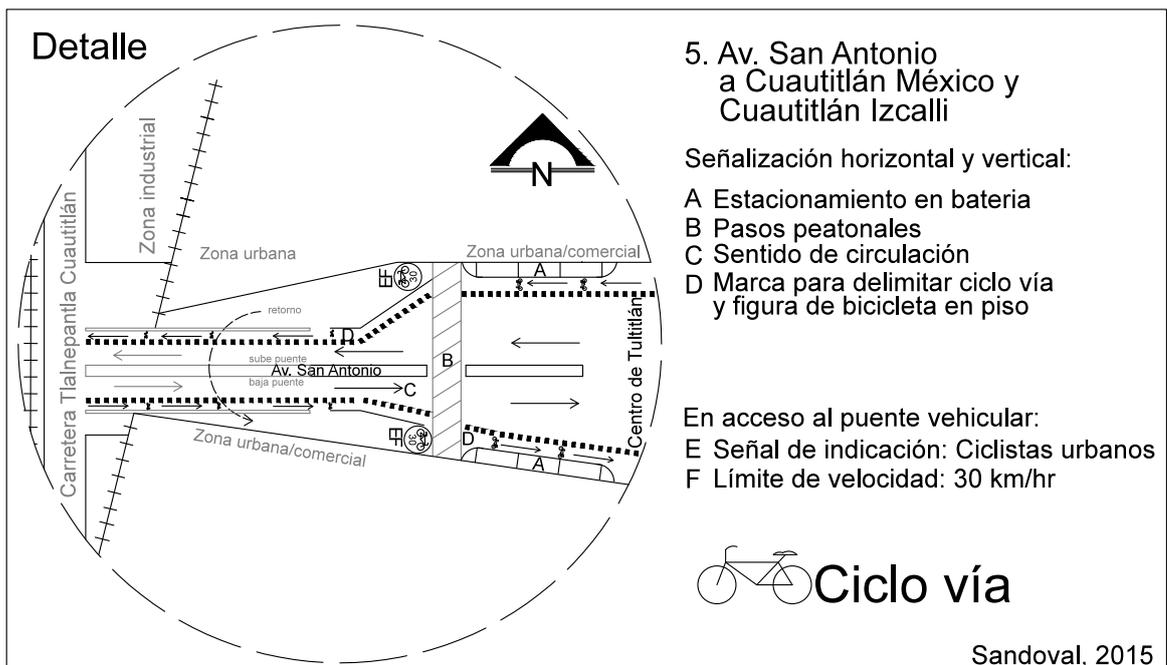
Detalle de puente vehicular de la Av. San Antonio. Fuente: La autora.
